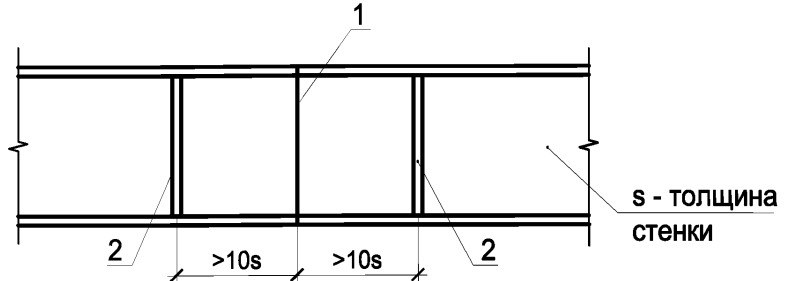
Примыкание ребер жесткости к поясам балки
